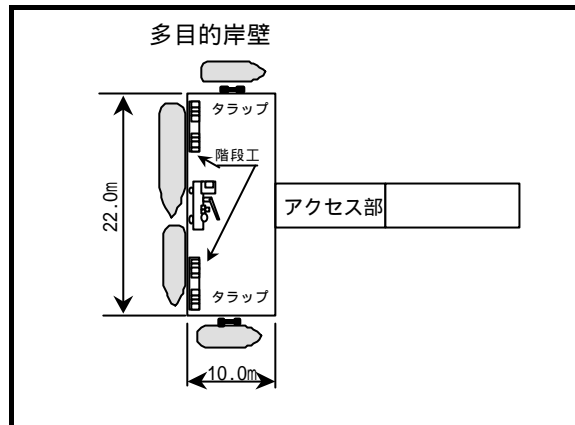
多目的岸壁の平面配置計画概要図
